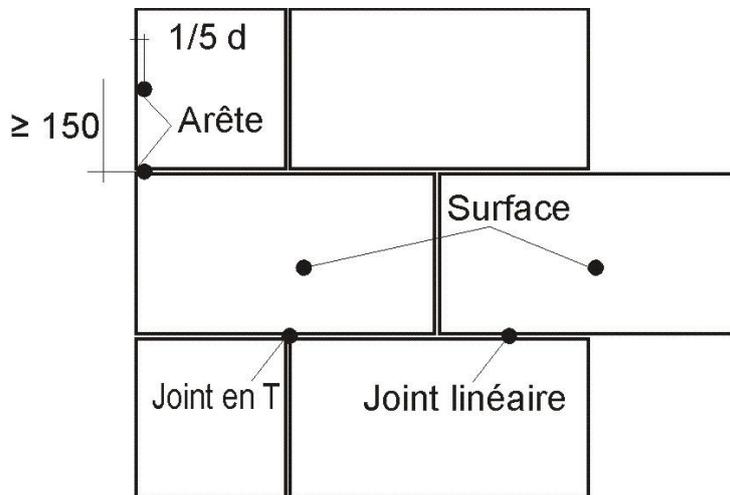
Points d'impact sur un élément de façade en pierre (dimensions en millimètres).
